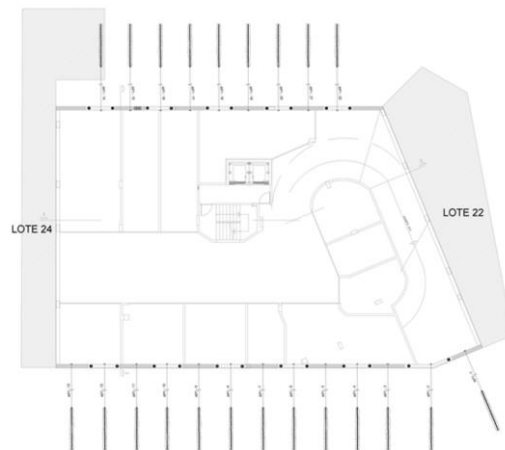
Ancoragens executadas no piso -1 (Geodrill, 2019)
